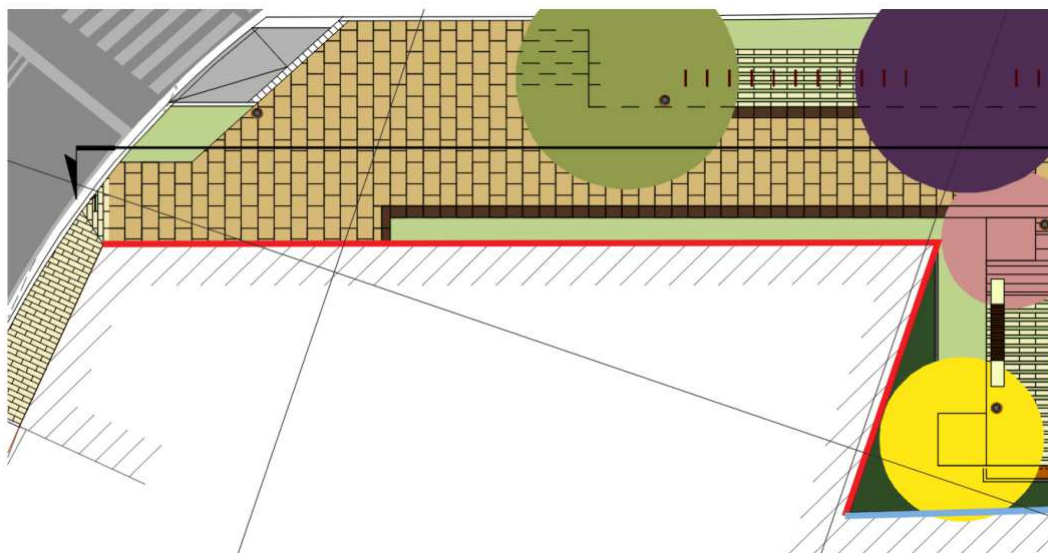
Planta de localização Muro 1 (linha em vermelho)
